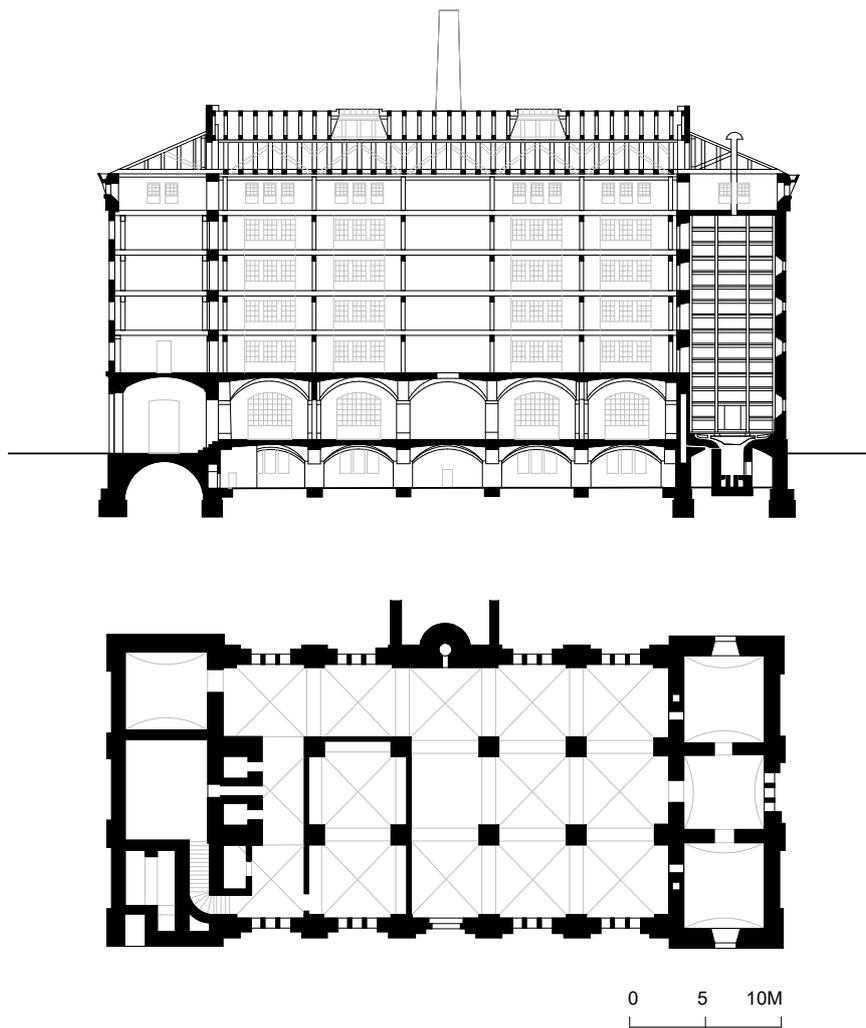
Zinersche Zuckerfabrik, Grundriss und Schnitt, Förster, 1839
